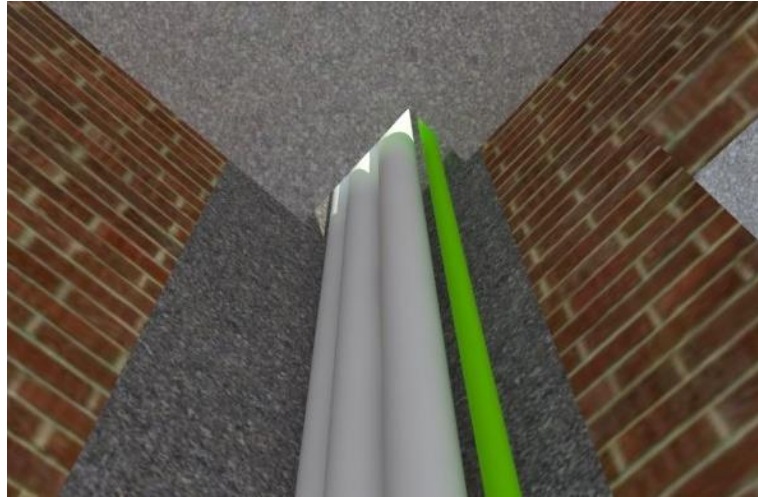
Laje apoiada sobre pilar em “L” com abertura (*shaft*) para passagem de tubulação
